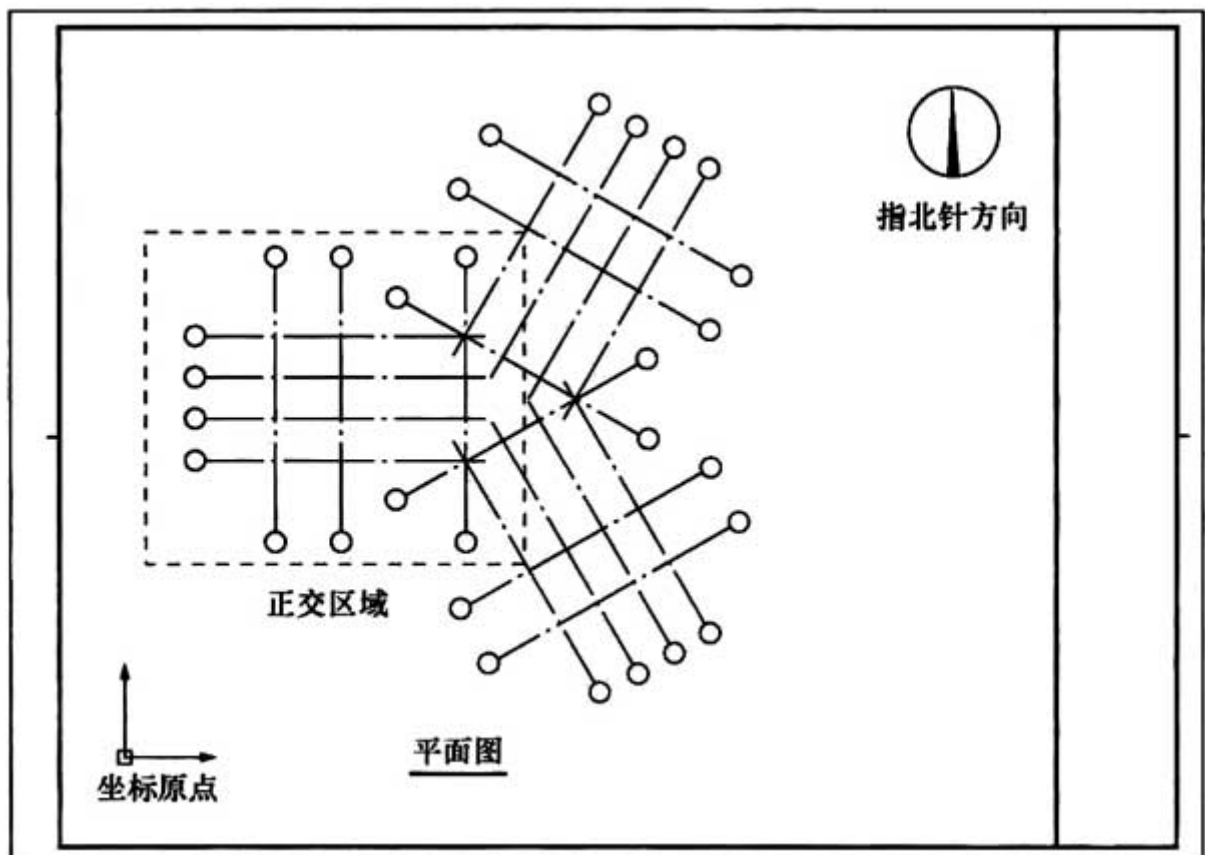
0. 1-2 正交区域相互斜交的平面图制图方向与指北针方向示意
